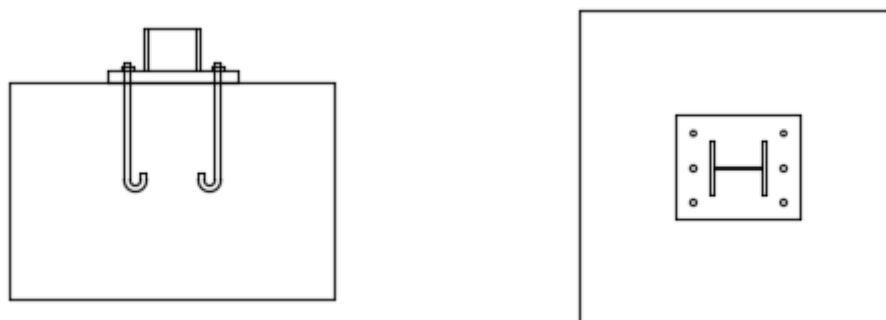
Alzado y planta de la placa de anclaje dispuesta sobre la zapata de cimentación.
